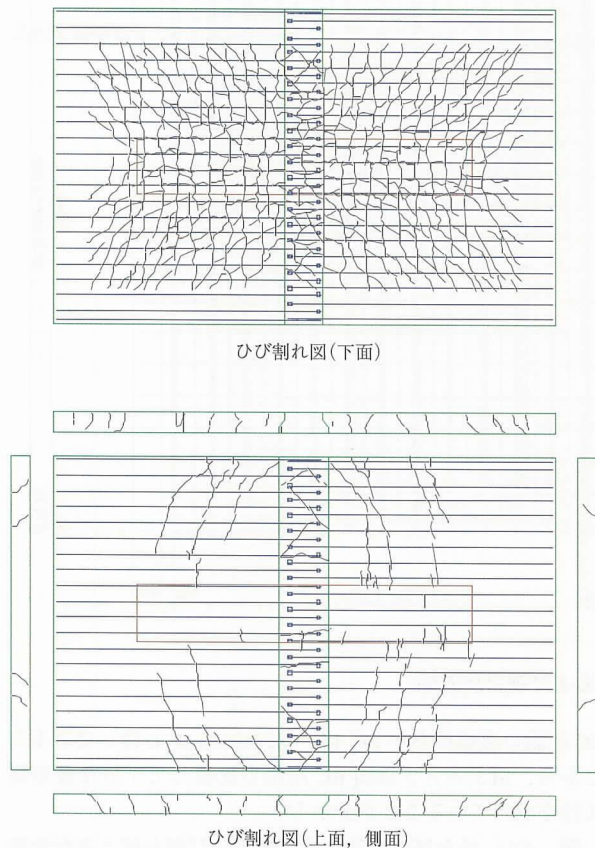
ひび割れ状況 (試験終了時 (走行回数 42 万回))
